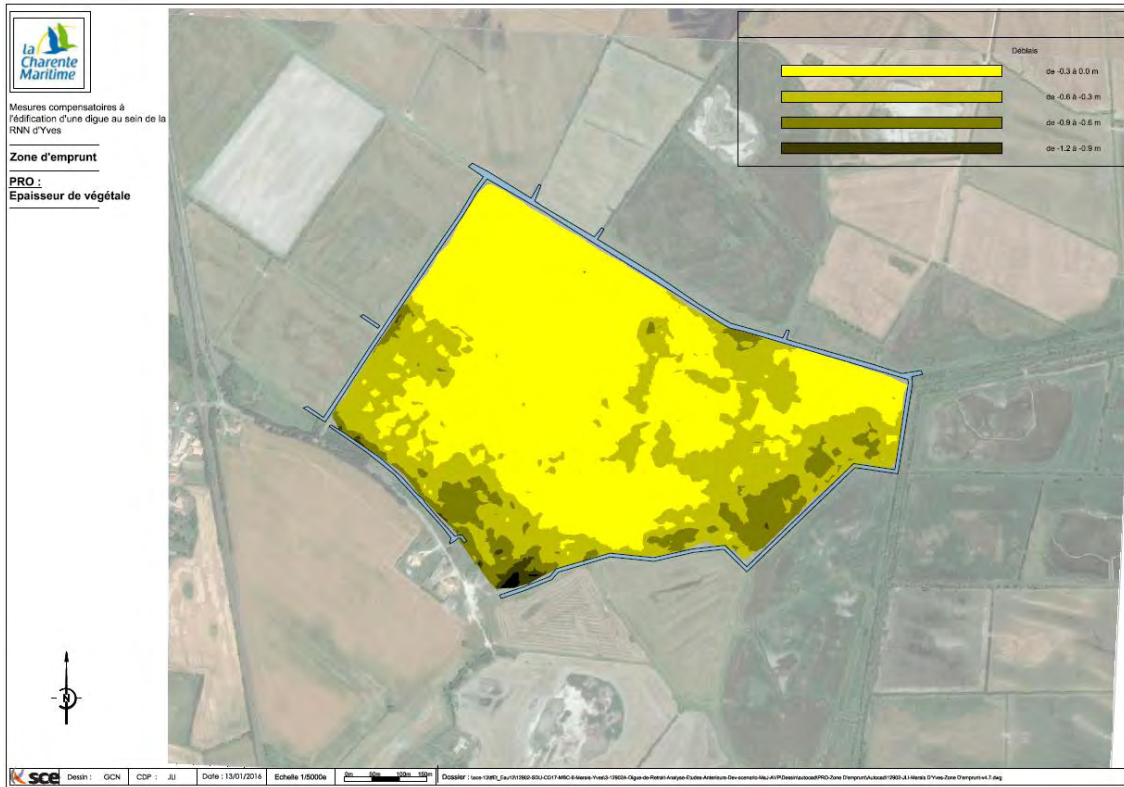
Plan d'extraction des matériaux de la zone d'emprunt (SCE – janvier 2016)
